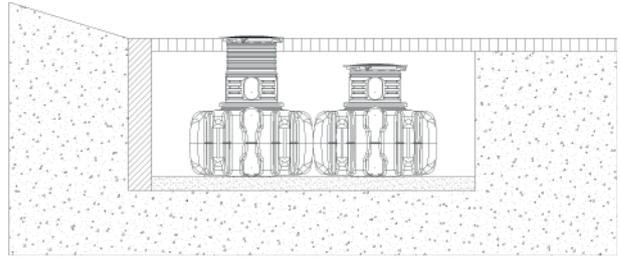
Einbau in Hanglage – Beispiel FLAT
